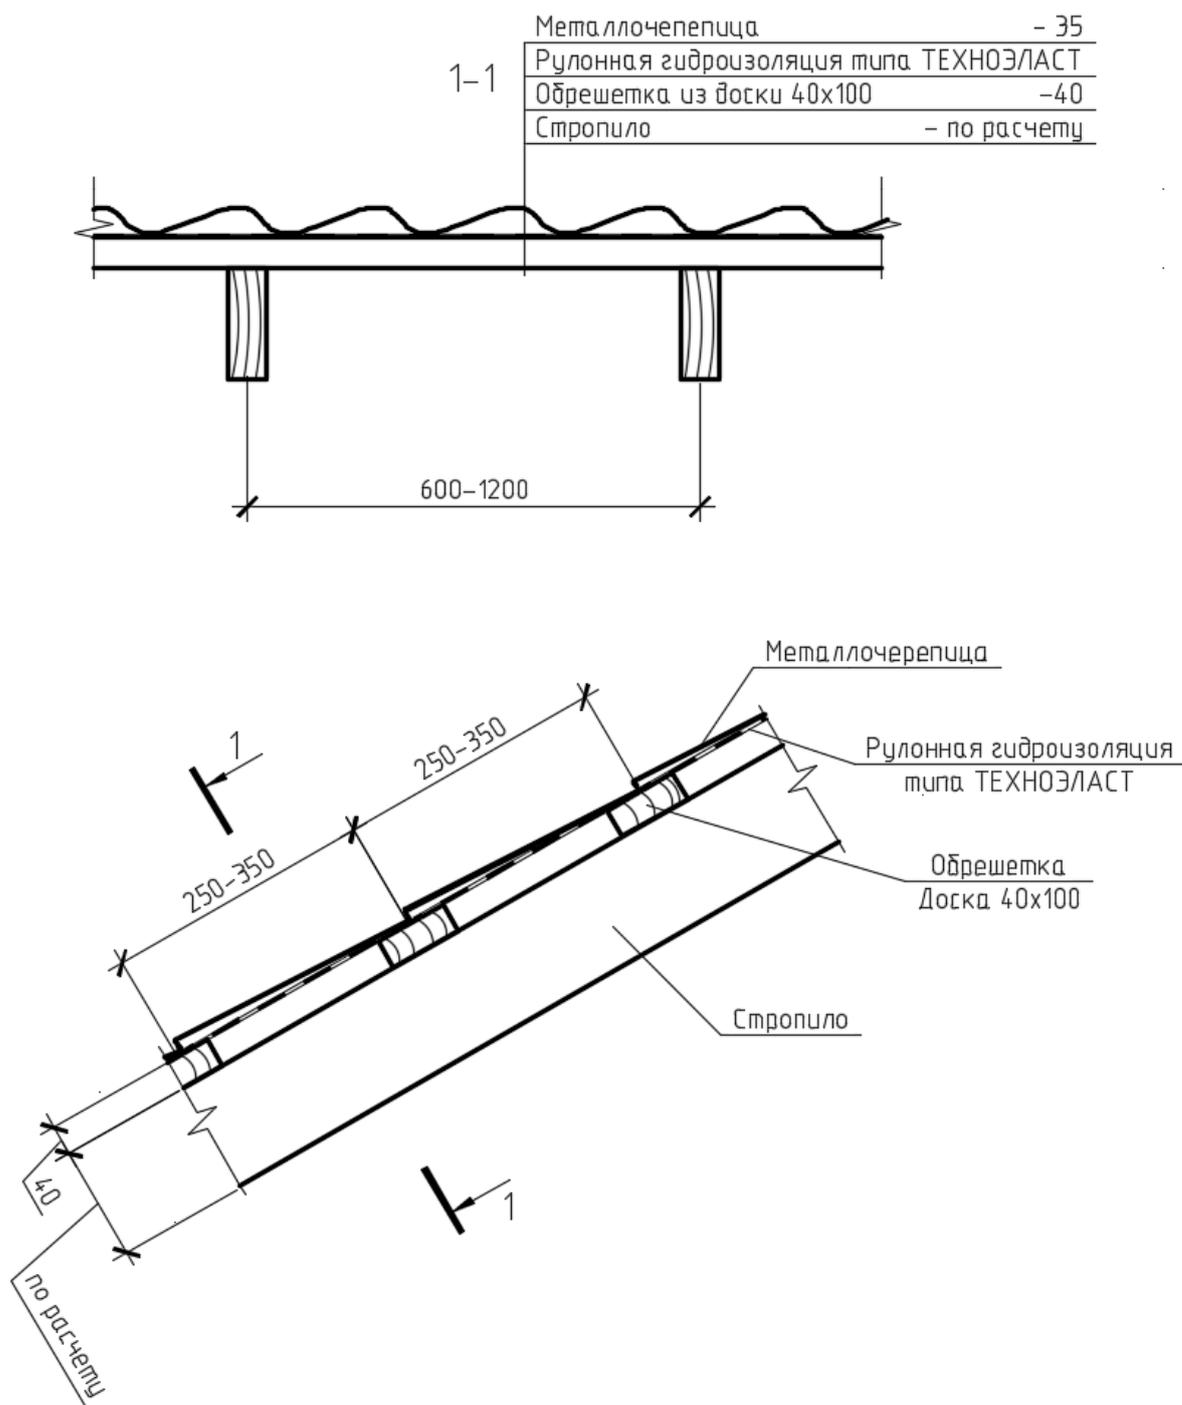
Пример решения холодной кровли с покрытием из металлочерепицы
